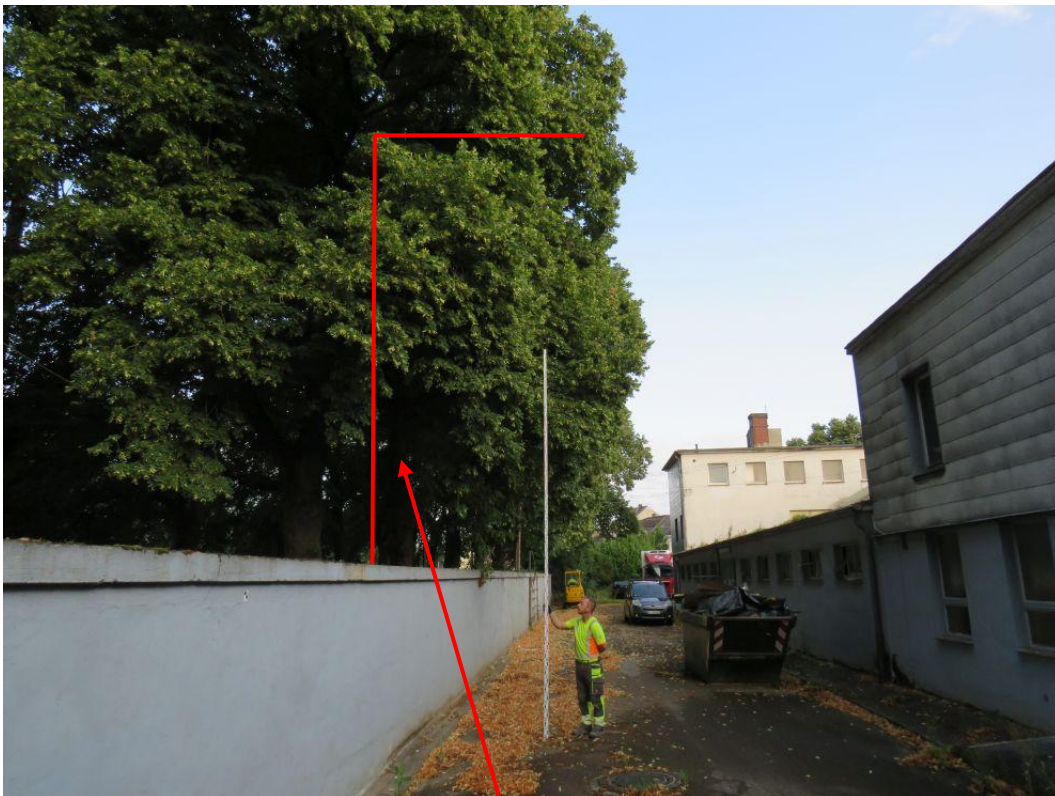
Baum 8 Erhöhung des Lichtraumprofils zur Errichtung der Werkhalle.
